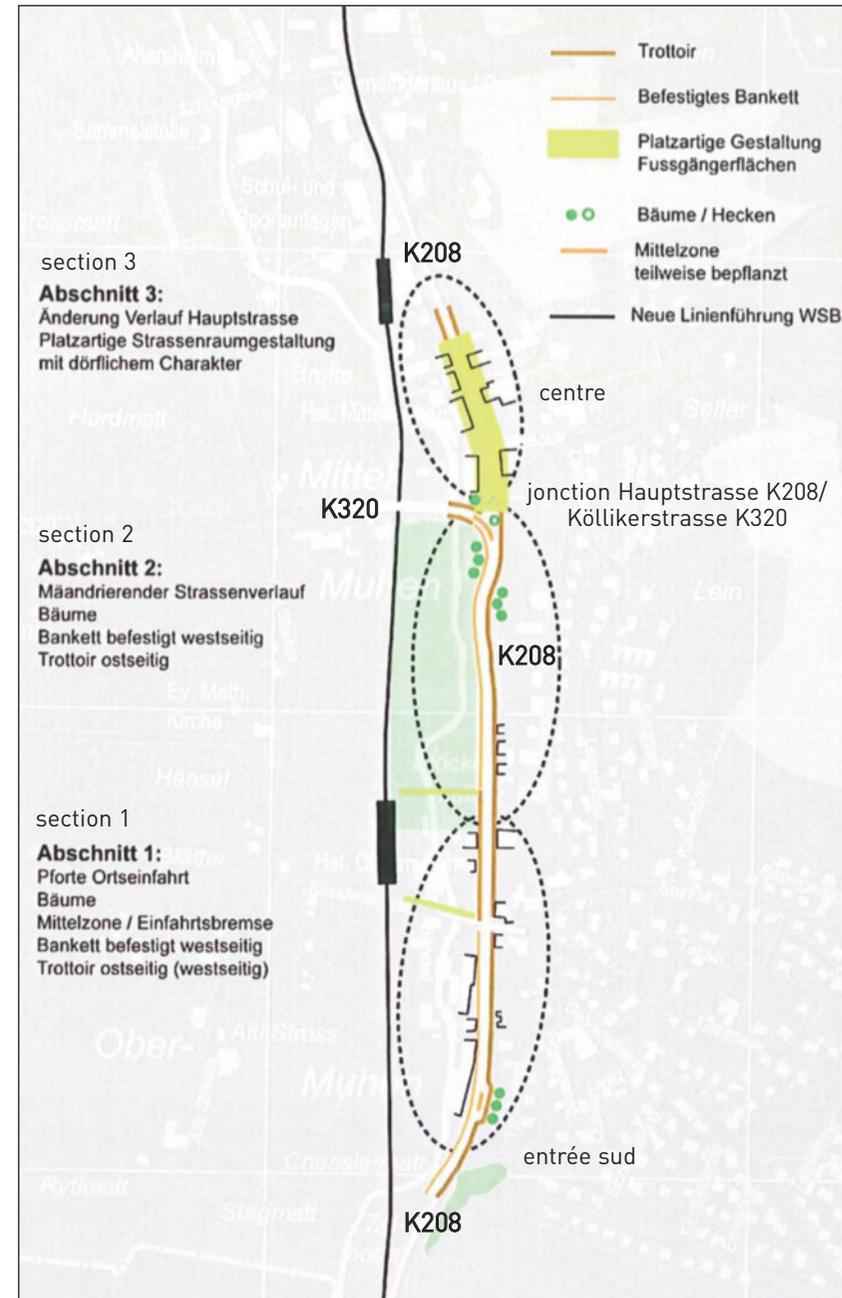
Hauptstrasse, concept par sections (source: Metron AG)
